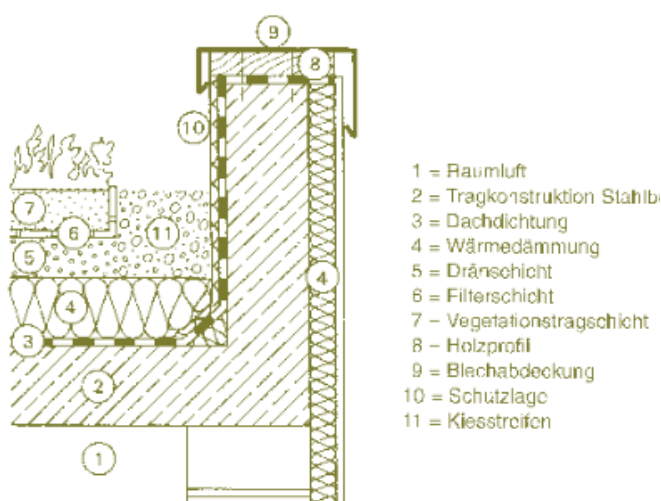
Dachaufbau begrüntes Umkehrdach
